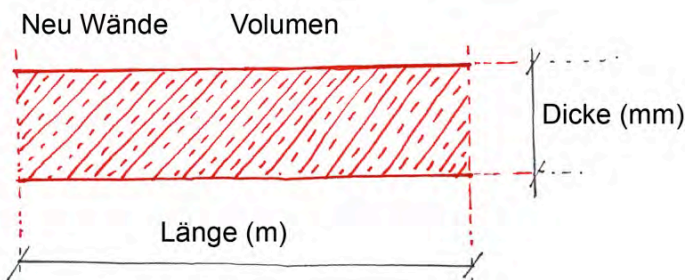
Vertikale Elemente , Gründung Neu Beton Wand
